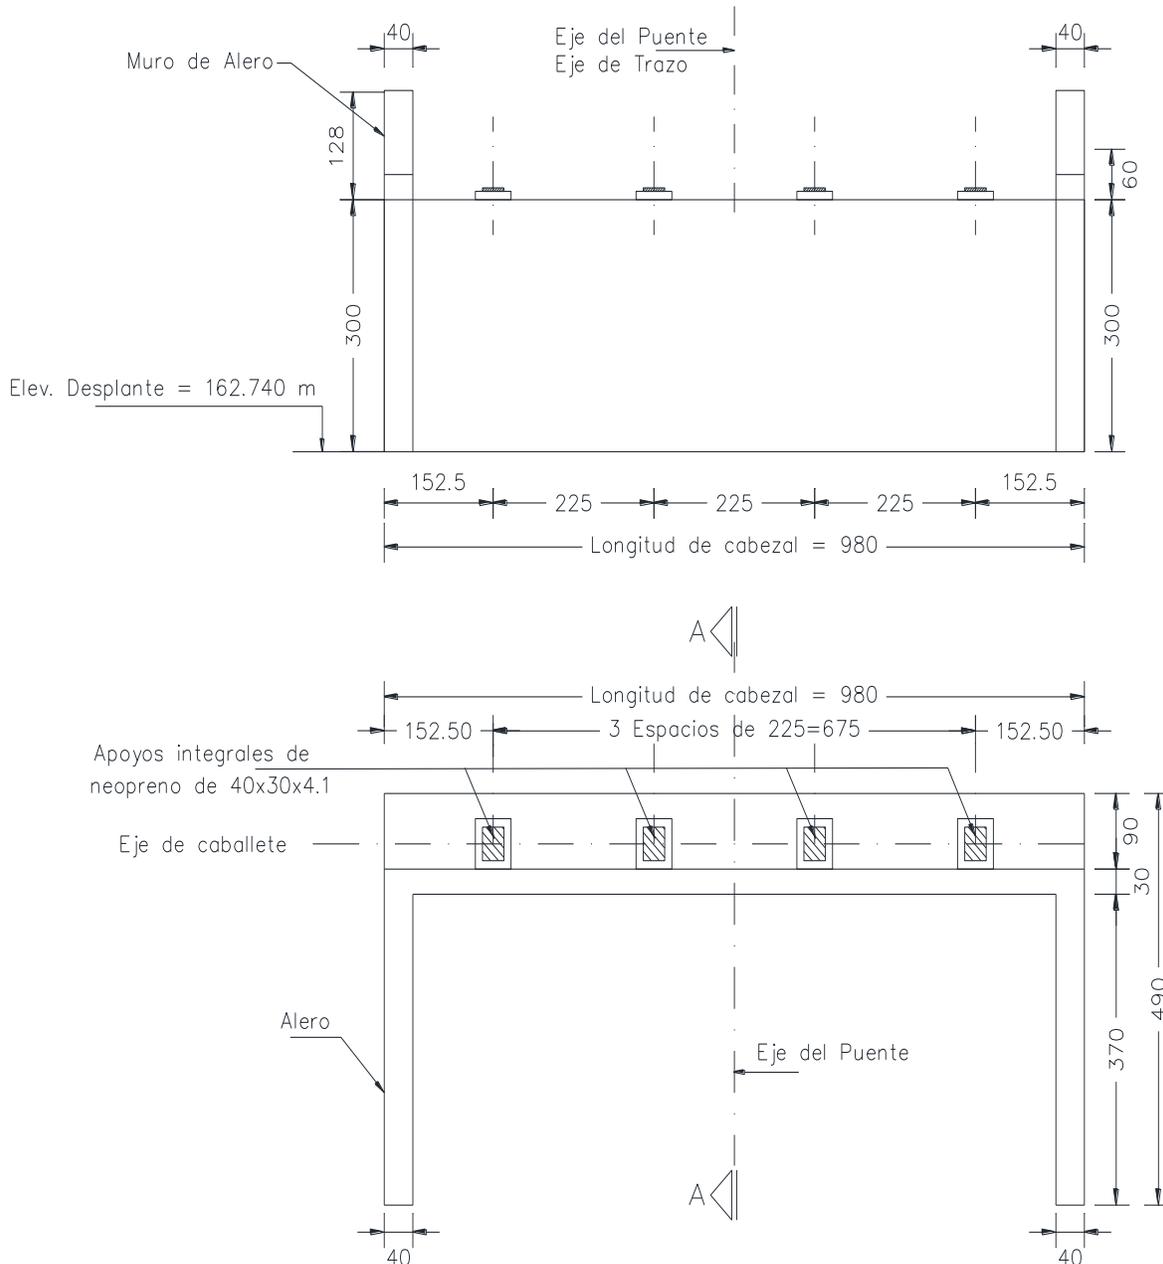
Vista frontal y vista en planta de caballetes No. 1 y 5.
